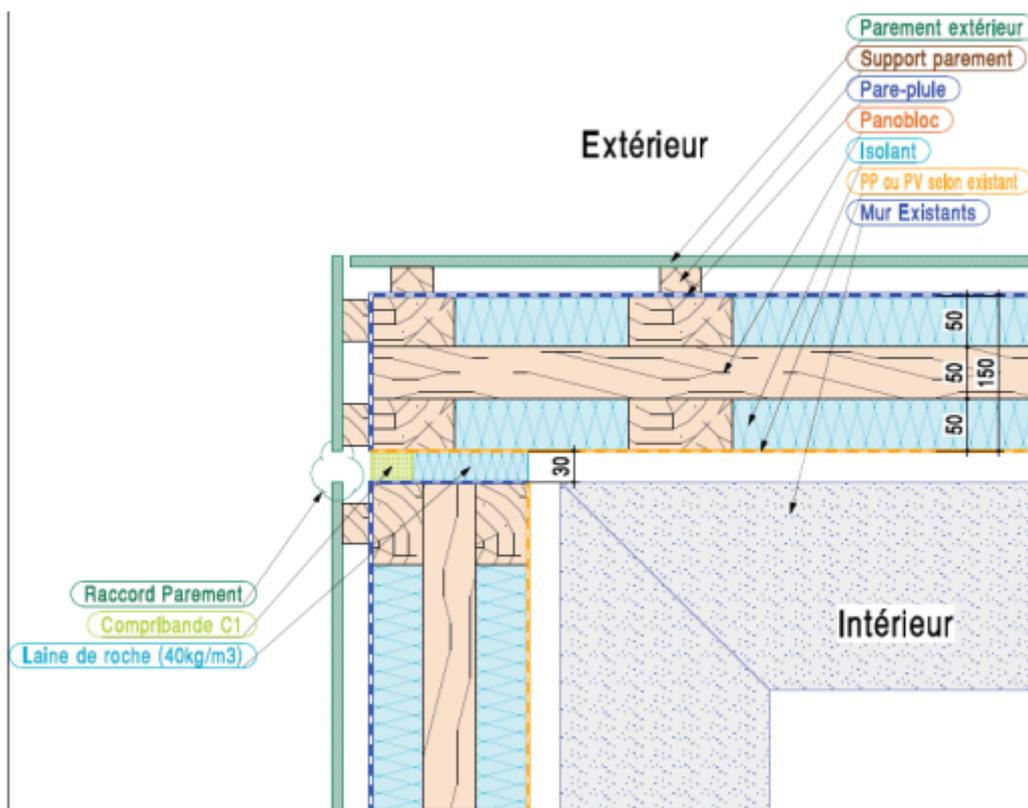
Angle sortant PANOBLOC® mur rideau parement extérieur ventilé / coupe horizontale
